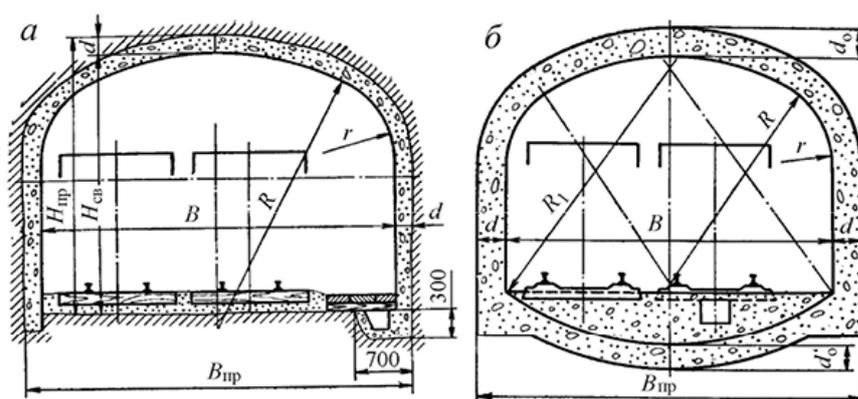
Монолитные бетонные крепи *а* – с вертикальными стенками и сводчатым перекрытием; *б* – с обратным сводом
